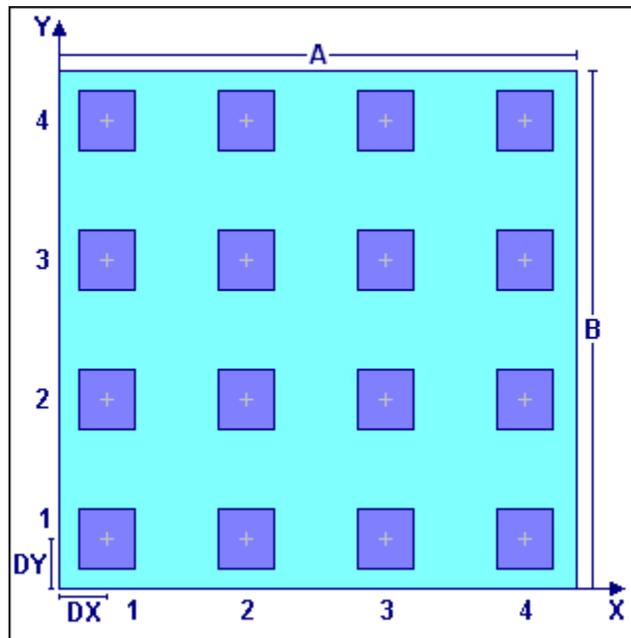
Sistema de coordenadas para losas de cimentación.
